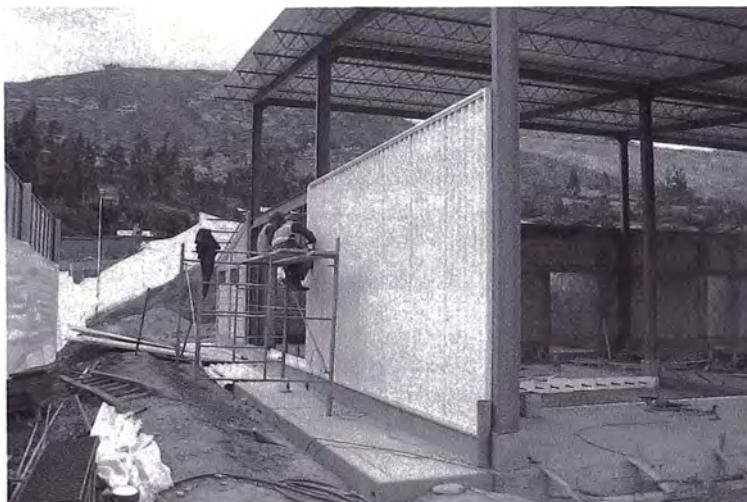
Instalación de Planchas de Cerramiento Lateral
